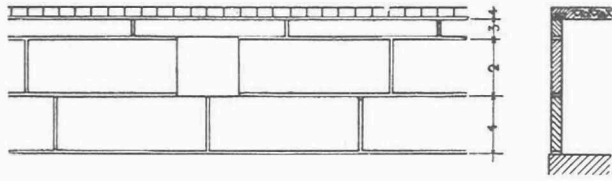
Schichtplan für ein Geschöß. 1 = Brüstungsschicht, 2 = Fensterschicht, 3 = Sturzschicht, 4 = Betonbalkenlage
